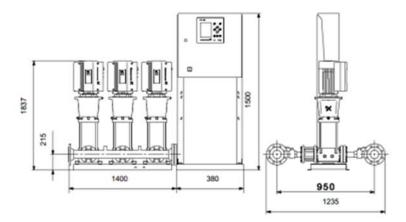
EXEMPLE DE GROUPE DE SURPRESSION REPONDANT AUX BESOINS DU PROJET (SOURCE : GRUNDFOS)
